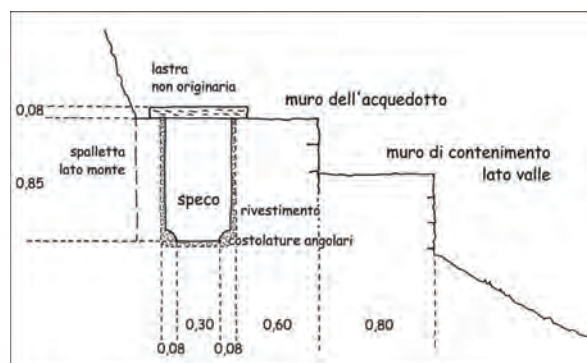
Sezione schematica del canale di adduzione (cat. nr. 10).
